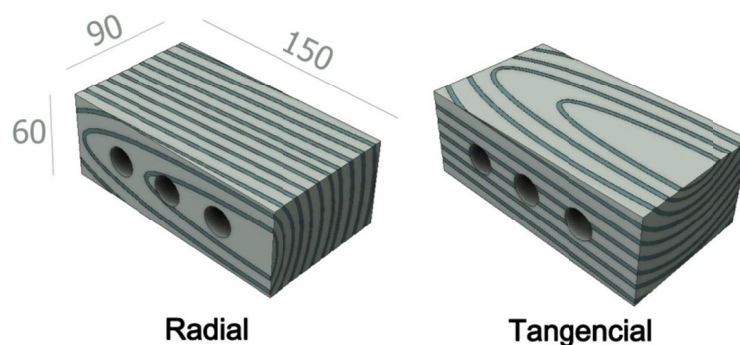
Probetas radial y tangencial. Dimensiones especificadas en milímetros
